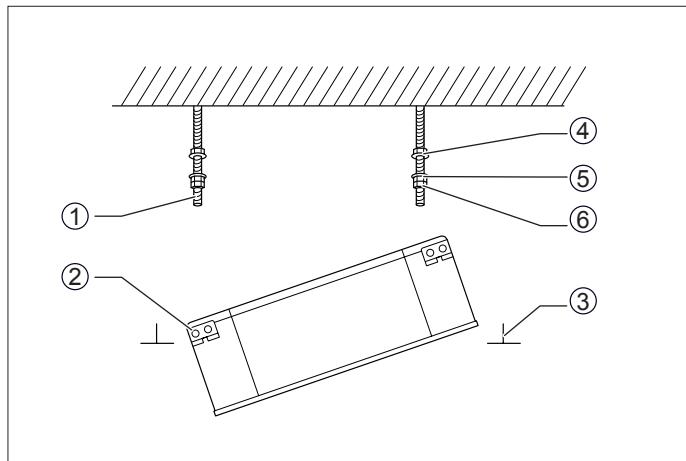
Inserimento dell'unità interna attraverso l'apertura nel controsoffitto.
